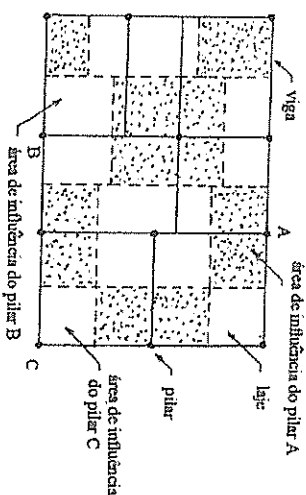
Esquema da estrutura de um pavimento e as áreas de influência dos pilares
